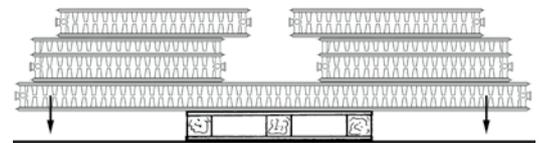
Falsche Lagerung führt zu Beschädigungen
